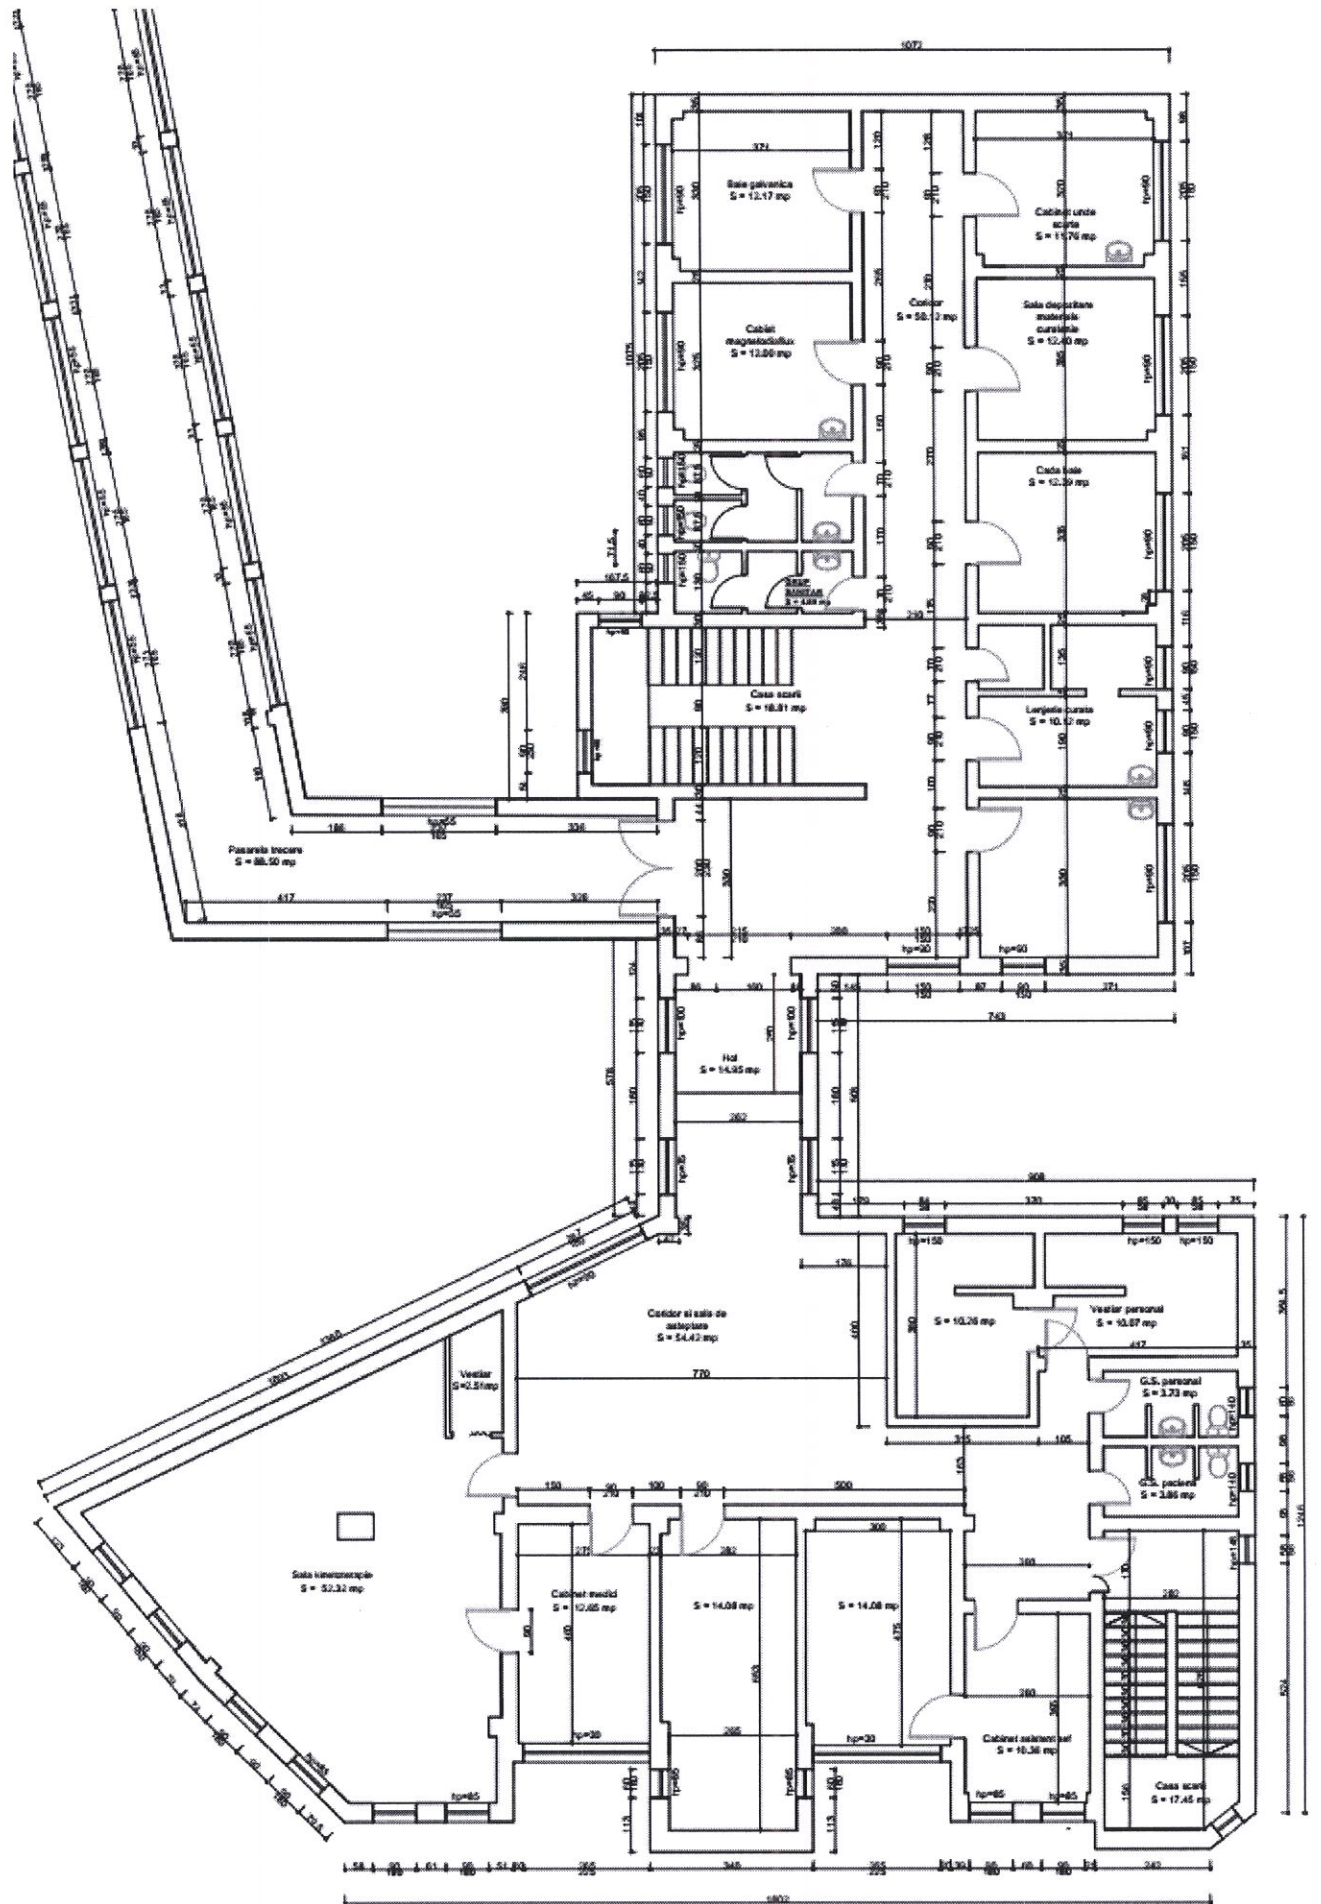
Plan etaj 1 existent Corp Tratamente C1+C2
